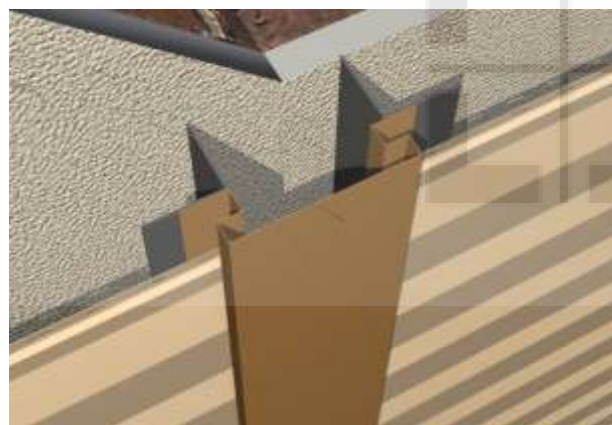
Монтаж сайдинга с использованием планки стыковочной сложной
